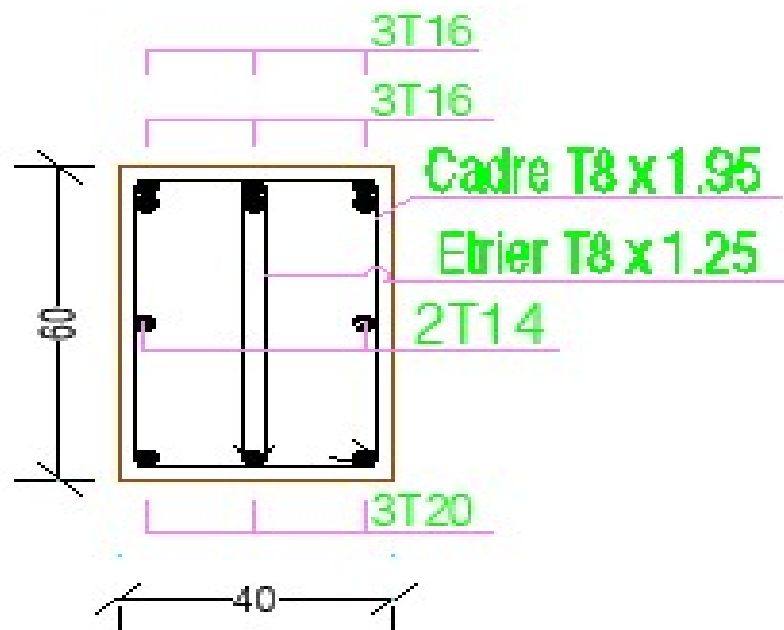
Disposition constructive des armatures des poutres sur appui
